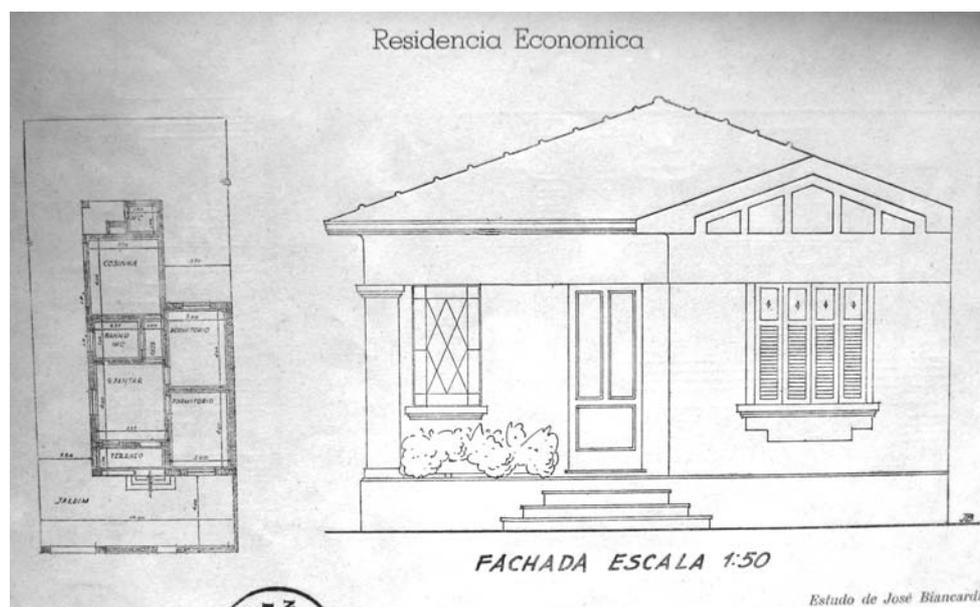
Estudo de residência econômica de José Biancardi, planta baixa e fachada
